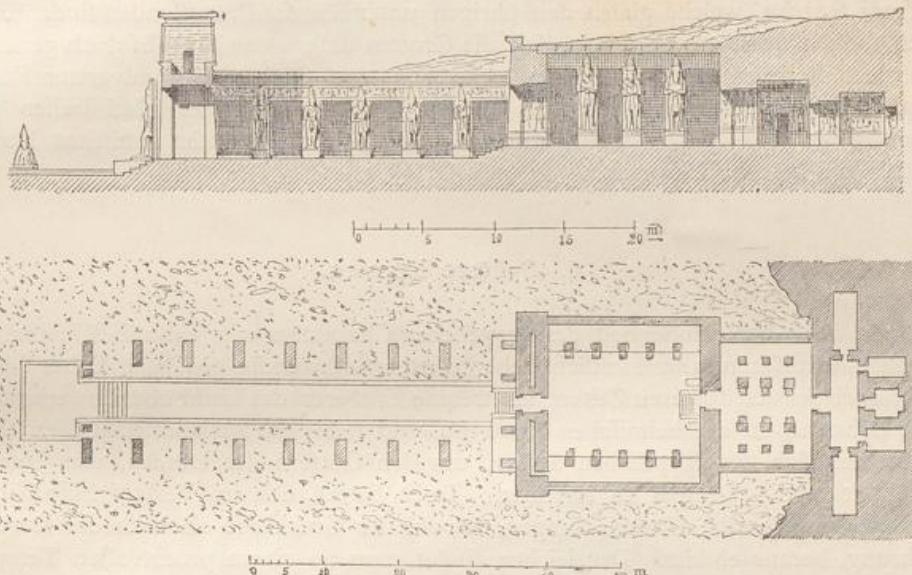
u. 21. Grotte von Girscheh. Grundriss und Längenschnitt. (Chapiez.)
